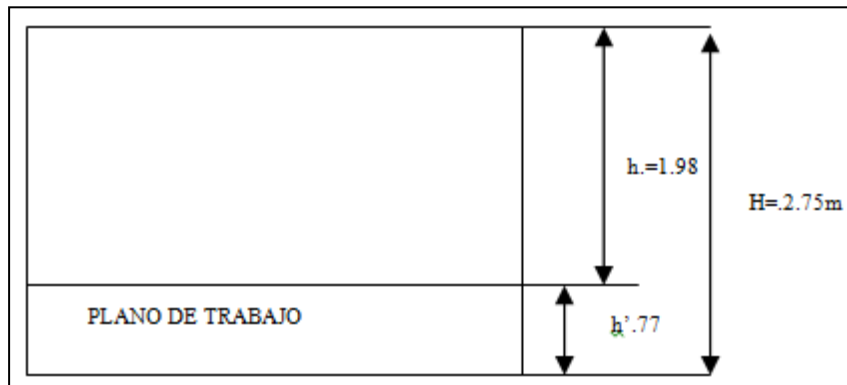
Esquema altura de suspensión luminarias al plano de trabajo
